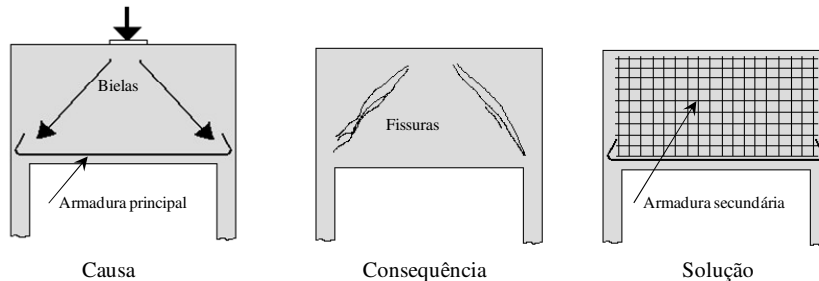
Exemplos de insuficiente armadura secundária viga parede
